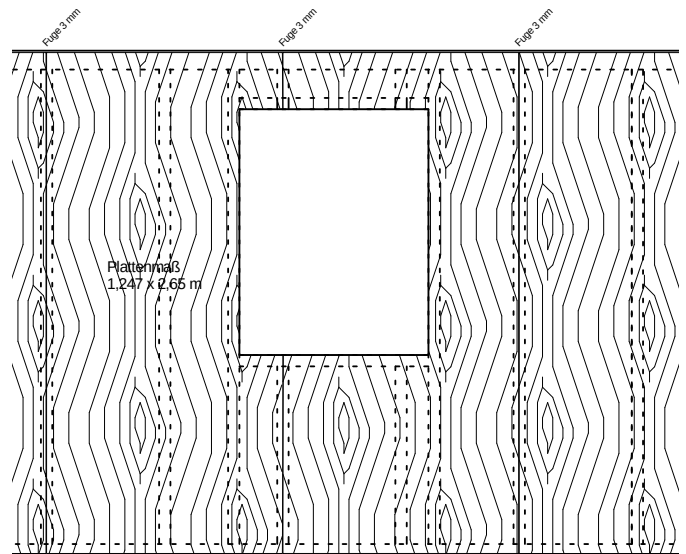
Die trockenen OSB-Platten werden mit min. 3 mm Fuge verlegt. Wichtig: geschosshohes Format verwenden. Alle Plattenränder müssen auf dem Rahmenwerk aufliegen und befestigt werden. Zur Luftdichtung sind alle Stöße vorderseitig zu verkleben.
